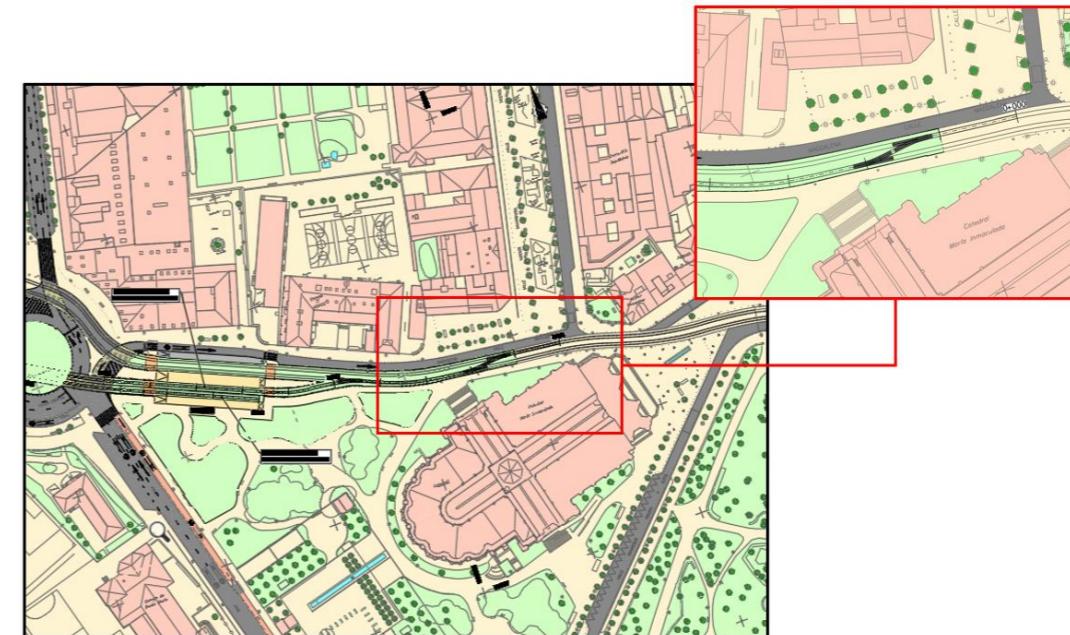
Afección a la línea existente: tramo Parlamento - Lovaina
